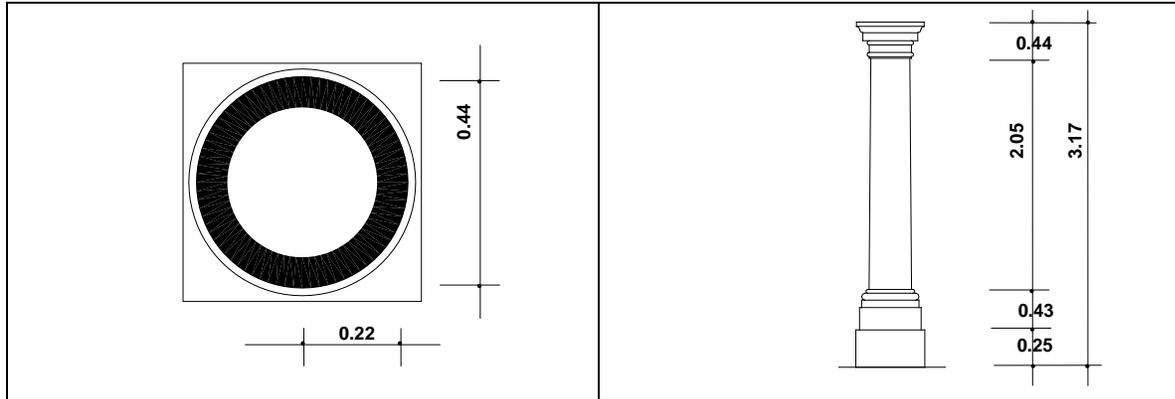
Diámetro y radio a la altura del imoscapo de columnas en planta baja, casa de Isidro Huarte.
